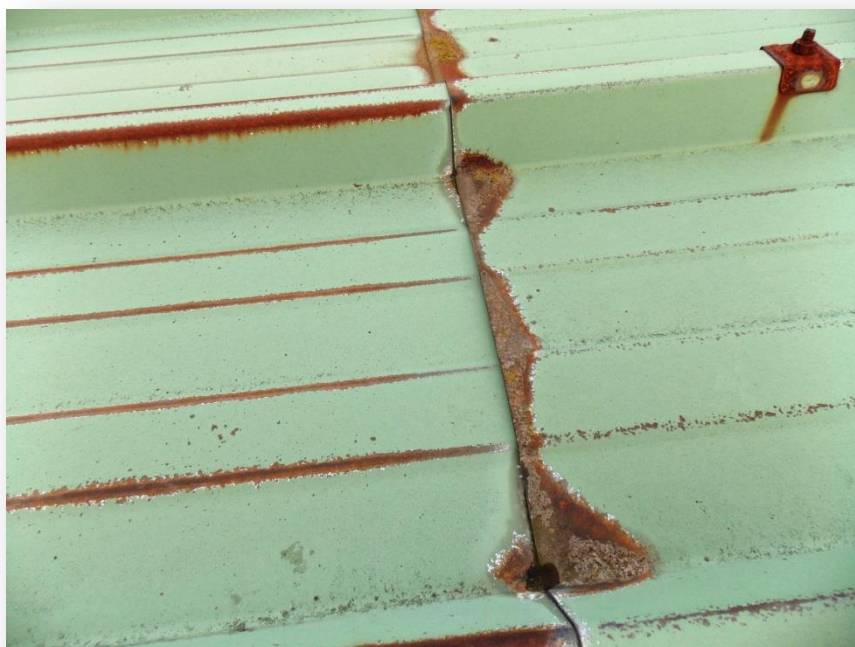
corrosion du bac acier de la toiture.
